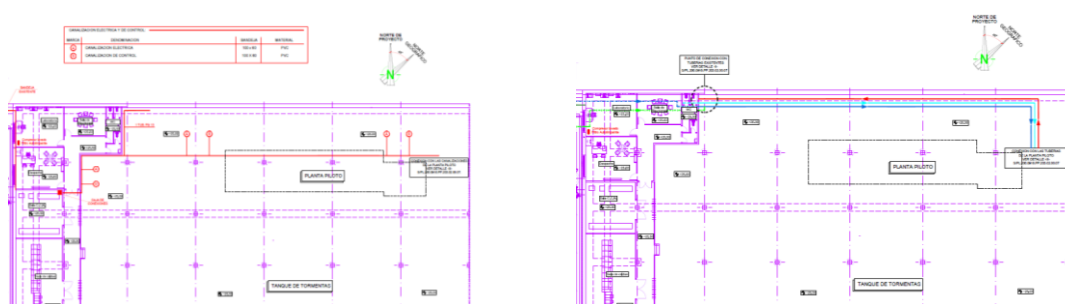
Vista en planta del recorrido de los servicios que abastecen a la planta piloto en la ubicación actual
